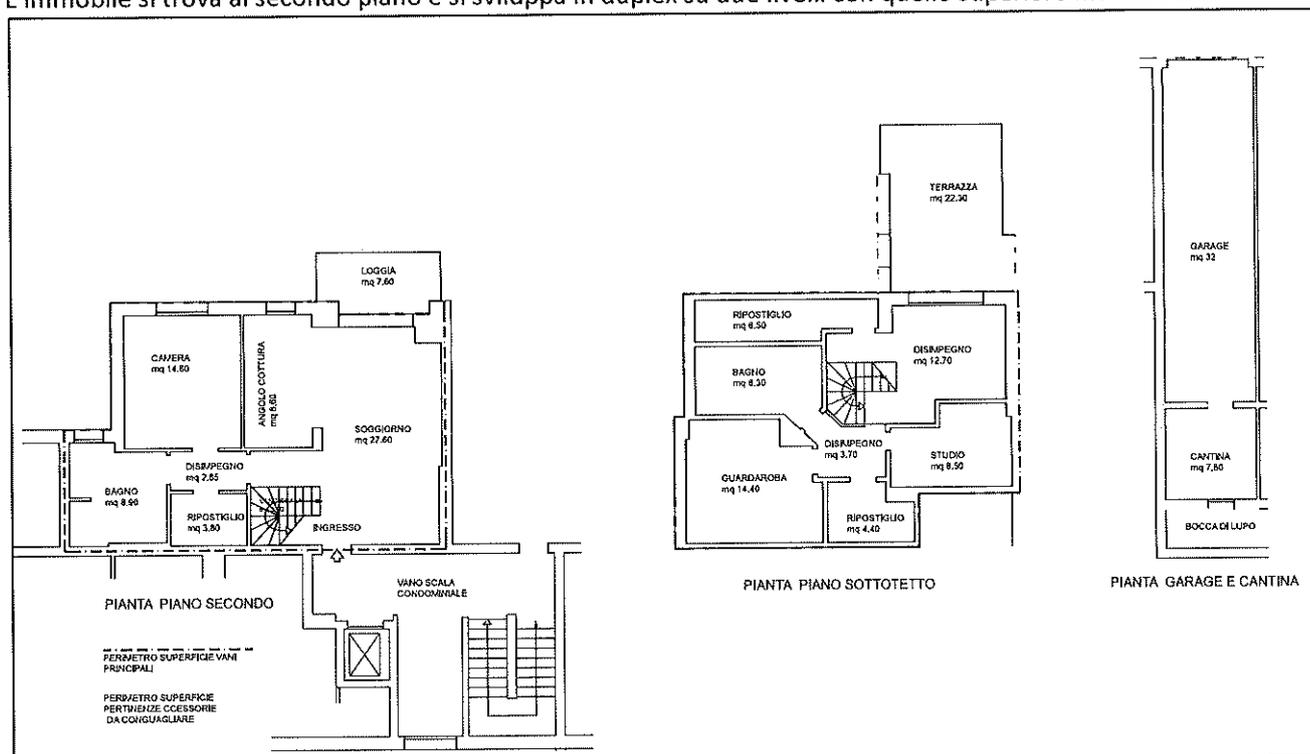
piante dell'appartamento rilevate in fase di sopralluogo
